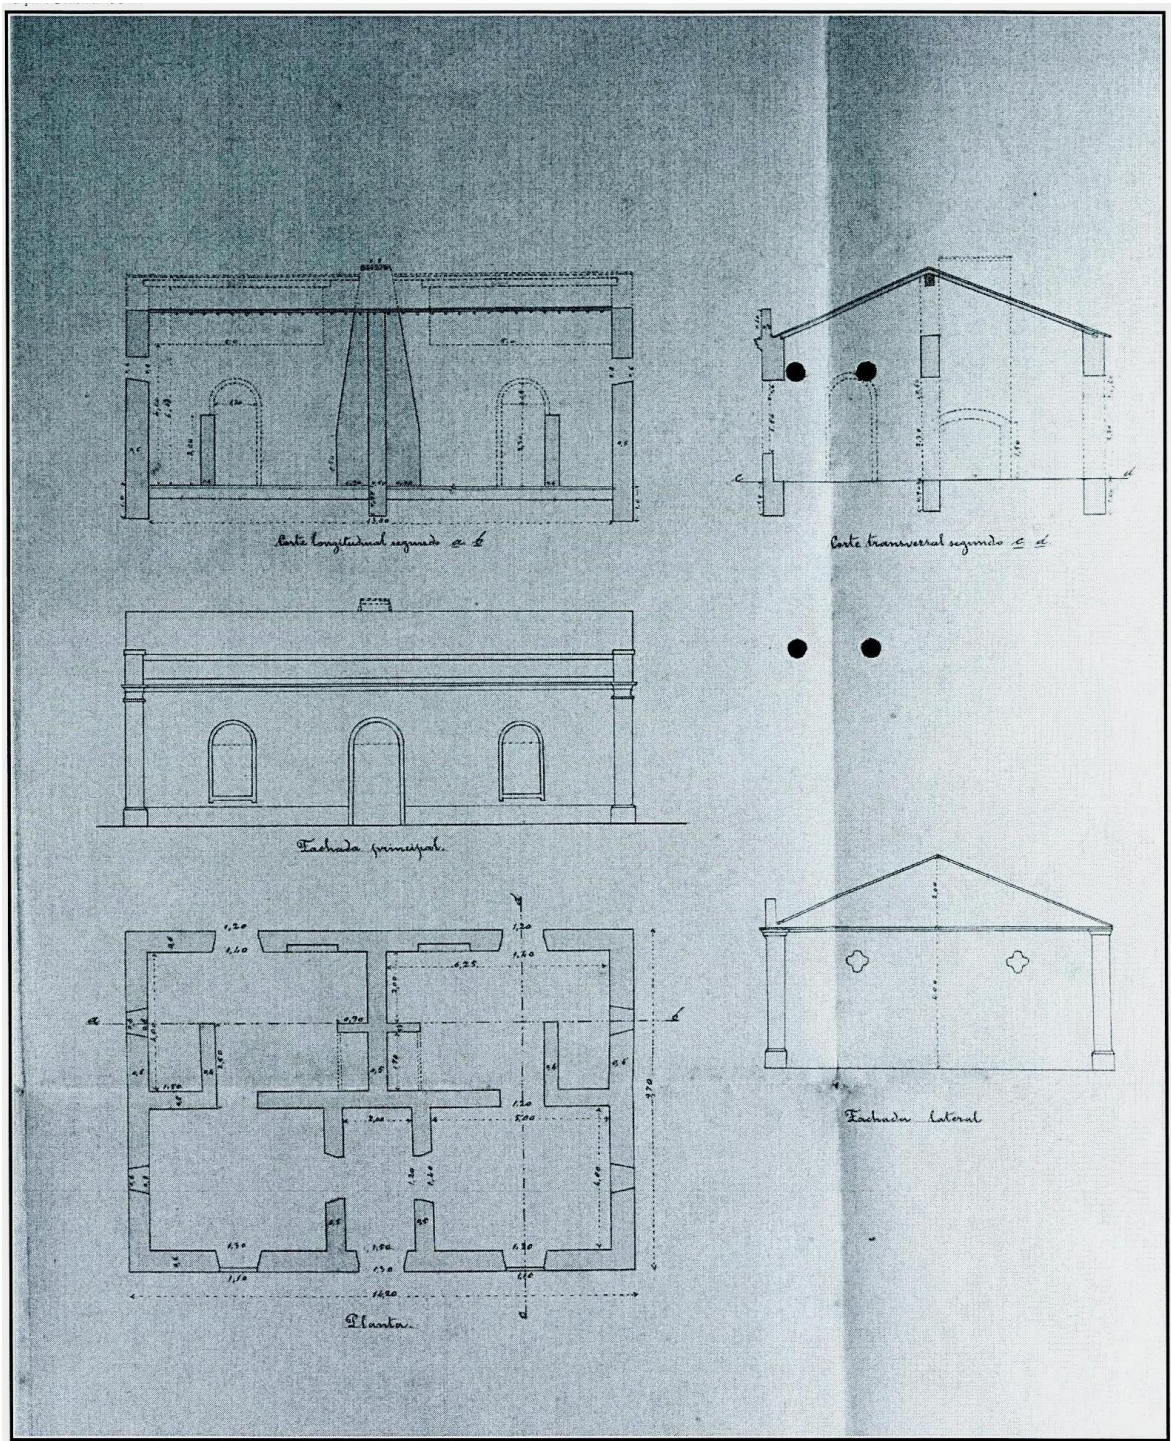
Planta, fachada e cortes d'uma casa para cantoneiros. (2)
